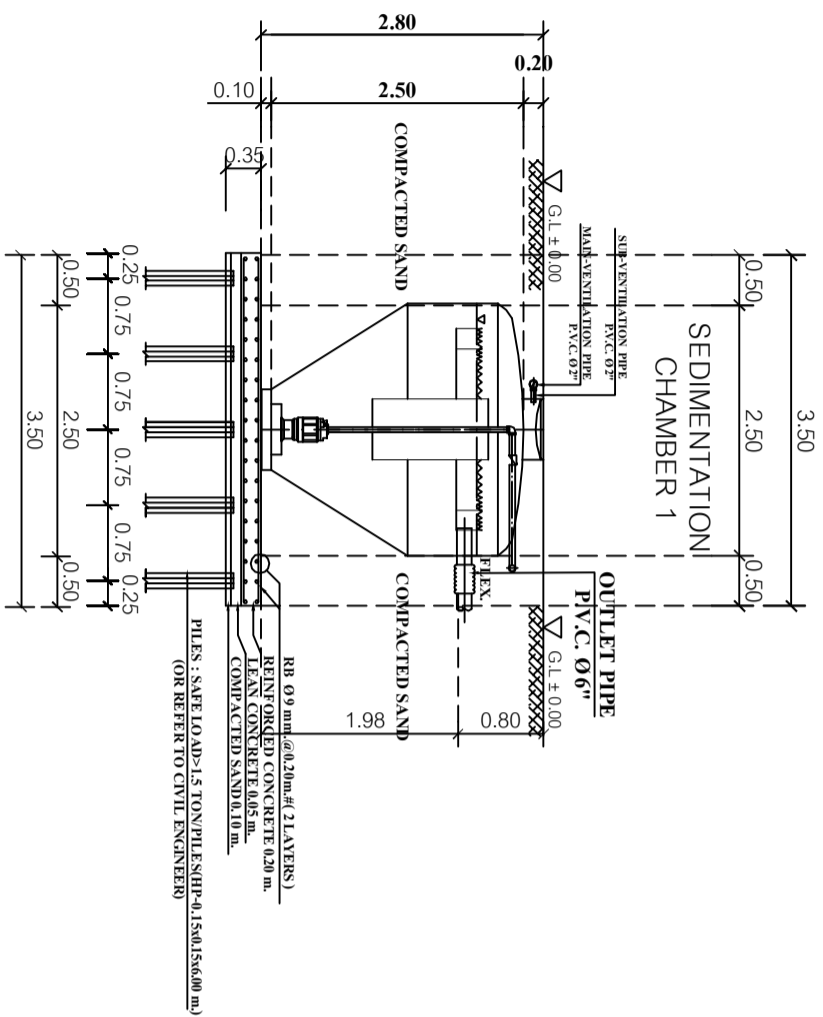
Section A-A และ Section B-B ระบับน้ำใต้ดินแยกต่างหาก 1
